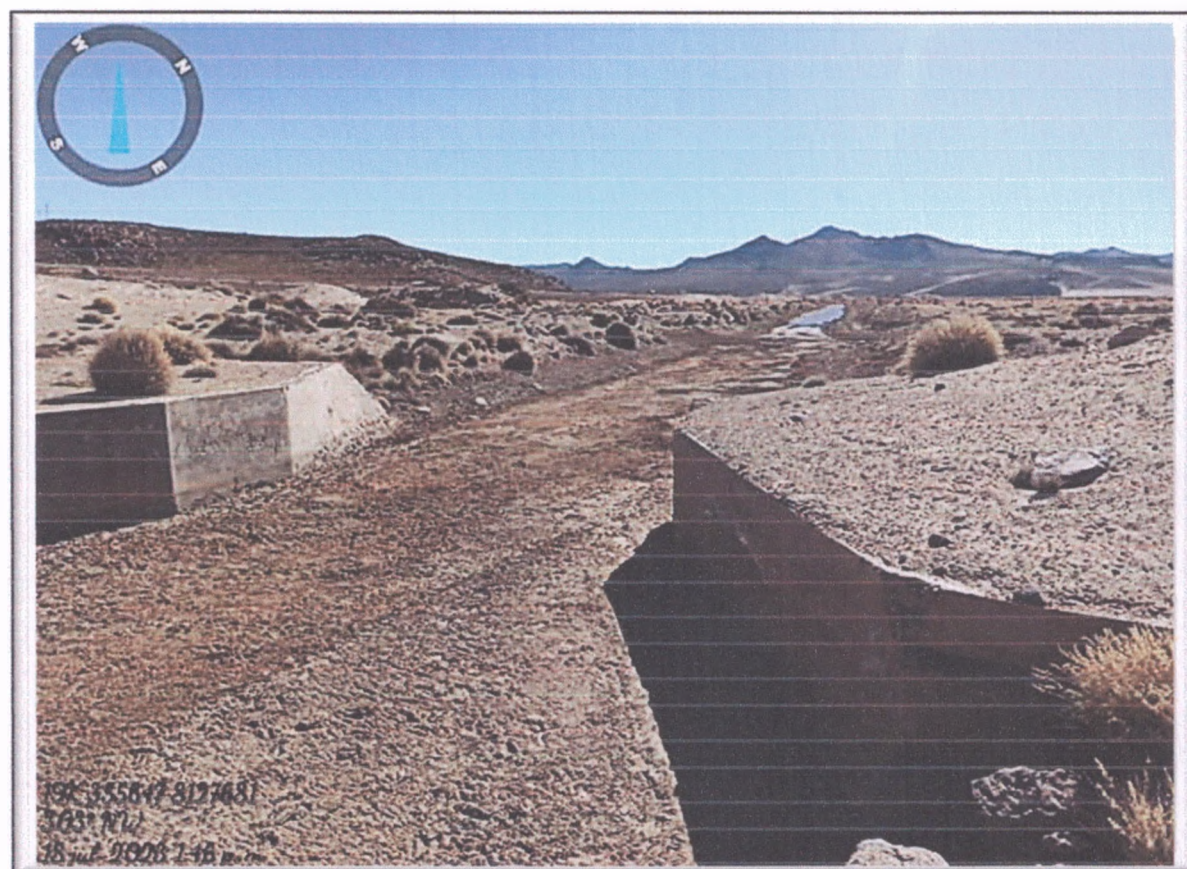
Vista de Pontón de Concreto Armado saturado de piedras y barro en
